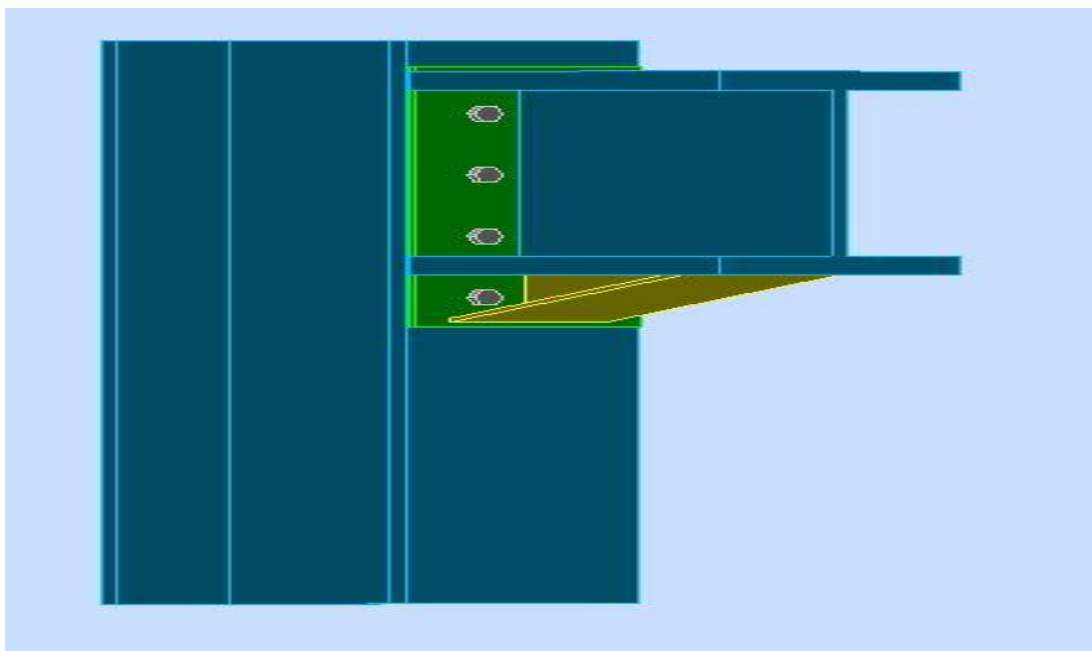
Vue 3D de l'assemblage poutre support du pont roulant poteau.
